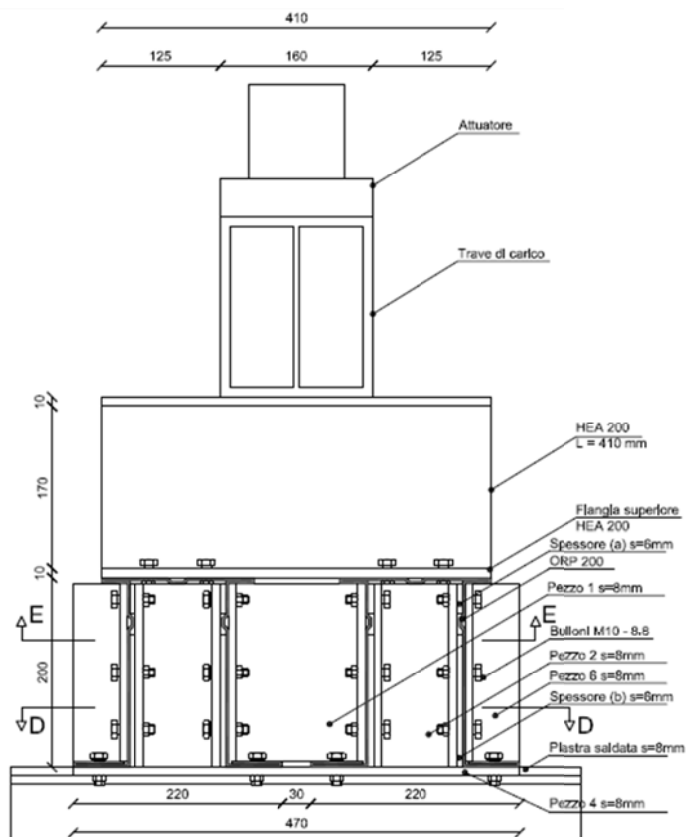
Stralcio elaborati di progetto: sezioni (1/2).
